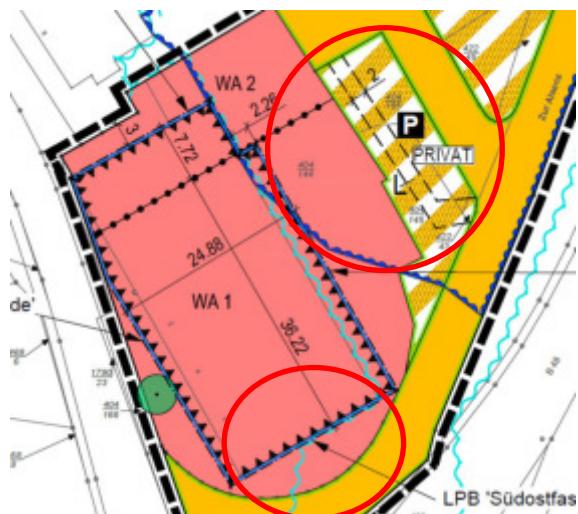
Entwurf zur Offenlage (alter Planstand)
